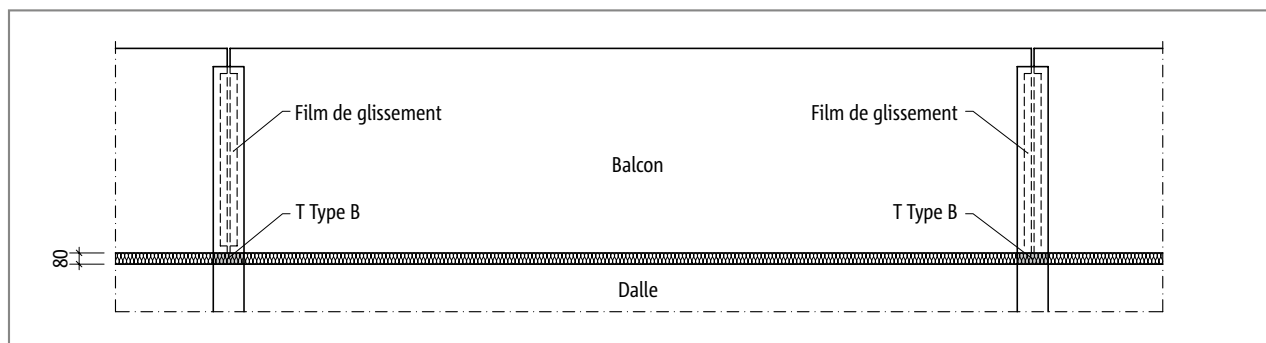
Schöck Isokorb® T Type B : Plan de base ; Résistance à la fatigue grâce au film de glissement entre les dalles de balcon et les poutres en porte-à-faux
